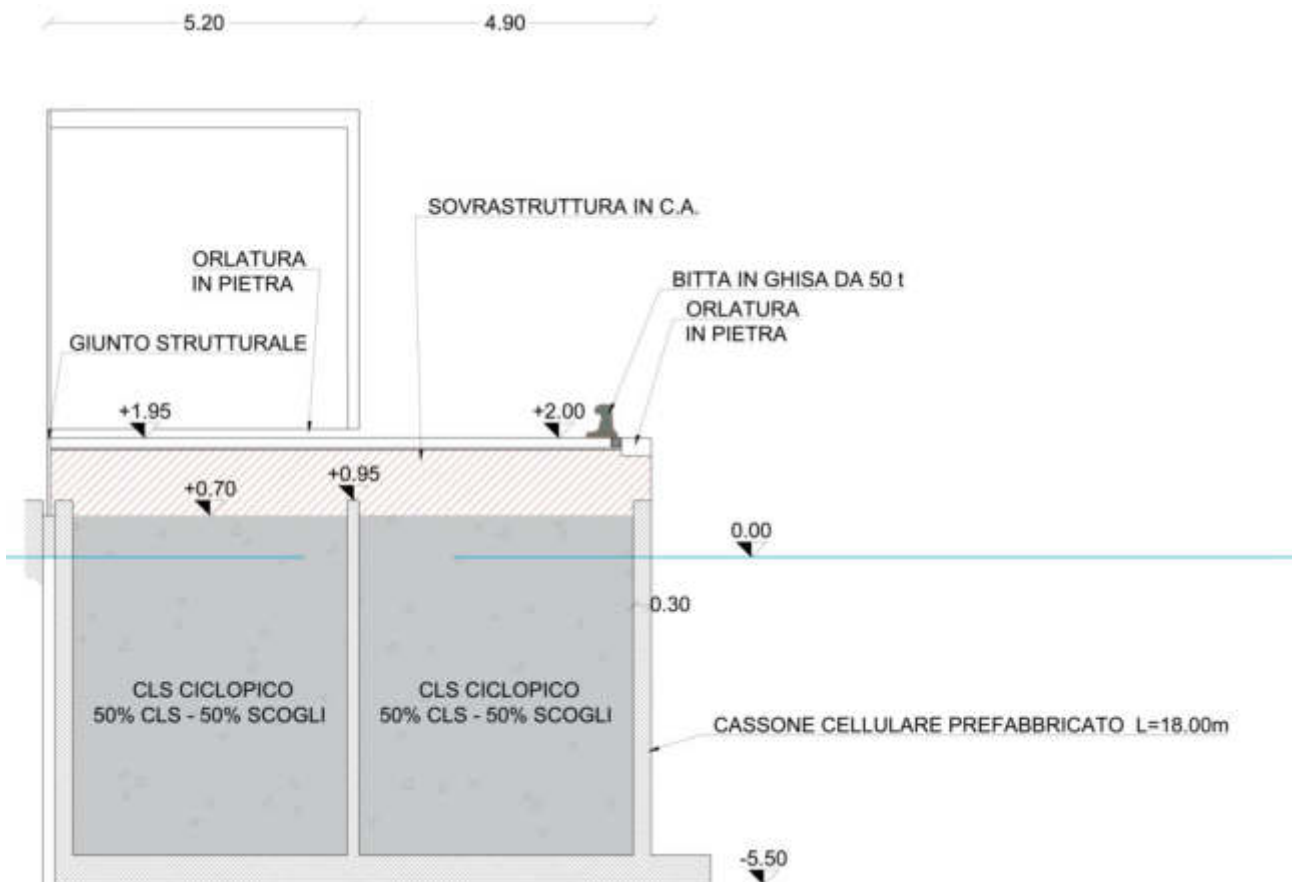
Sezione trasversale cassone di testata lato interno – sovrastruttura - muro paraonde.
